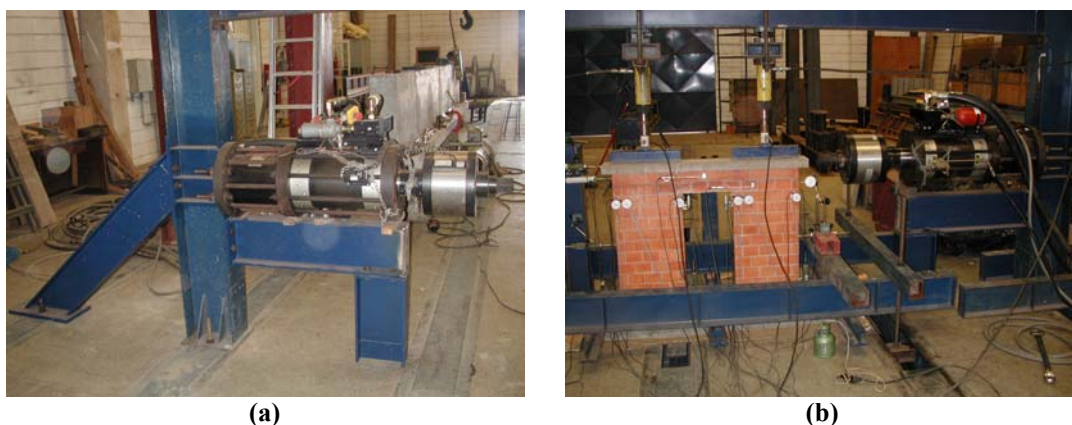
Disposição de ensaio utilizada: (a) Apoio para o atuador horizontal e reforços na coluna do pórtico; (b) Cilindros verticais para aplicação da pré-compressão e travamento da laje de apoio do painel.
